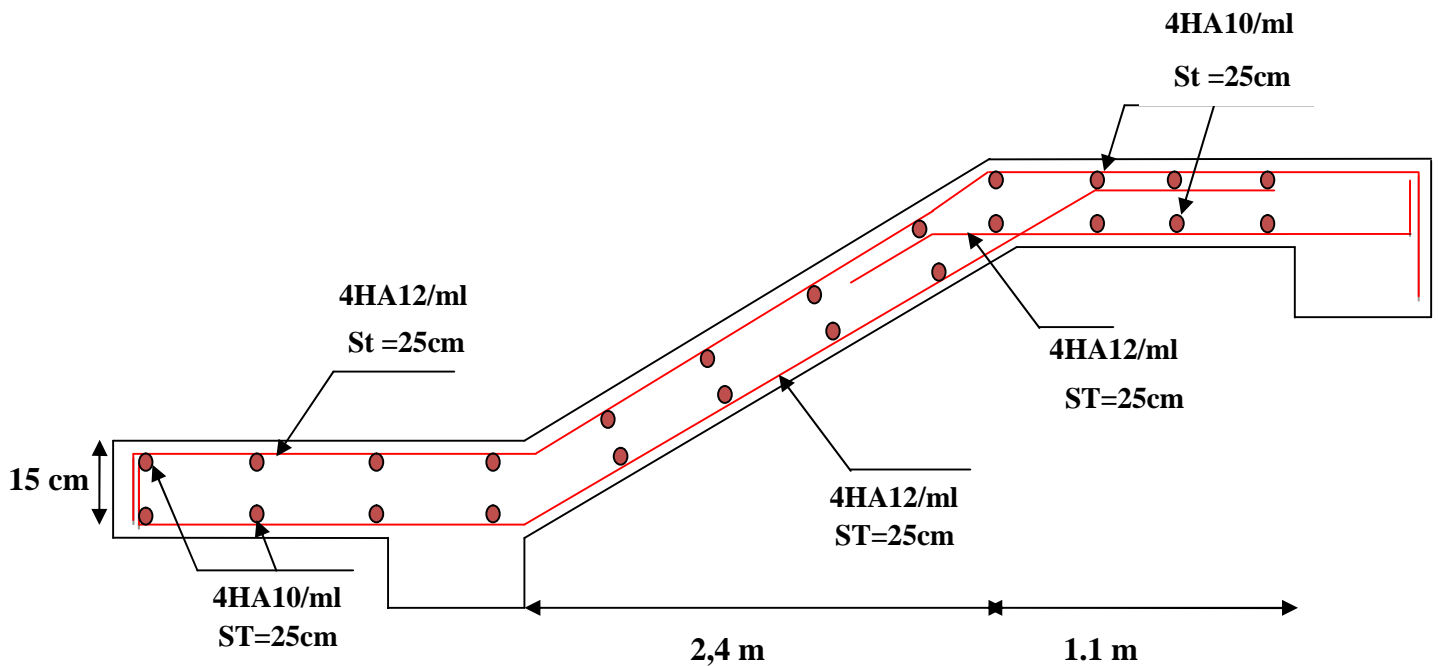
Schéma de ferrailage de l'escalier type 2
